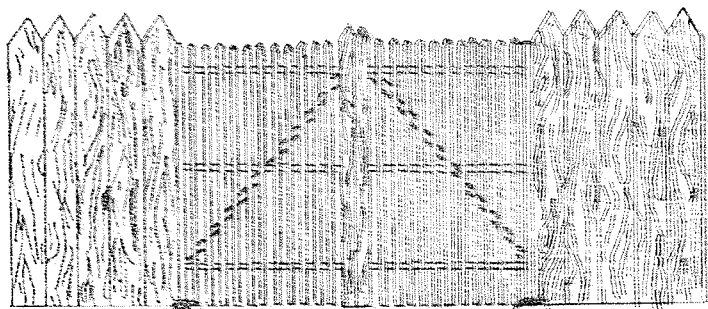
Destrucción de una barrera por cargas colocadas en el pie de las jambas
